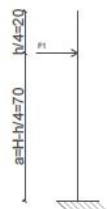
schema statico adottato per studiare la parete del pinto a bicchiere
